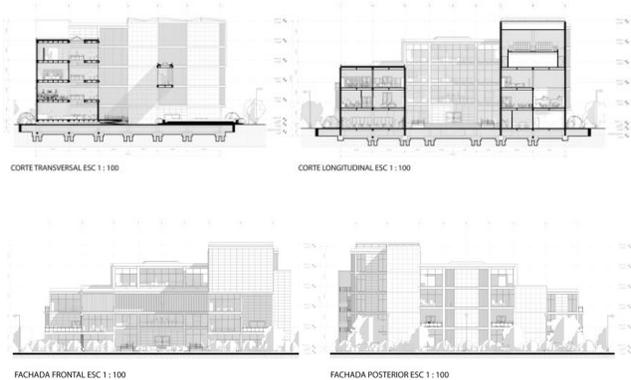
Elaboración propia. 2021. Cortes / Fachadas
